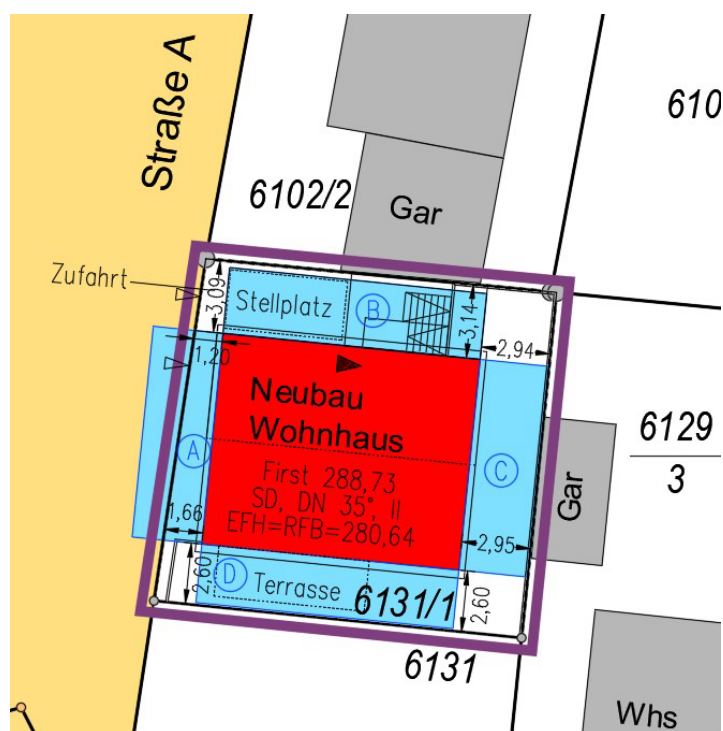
Beispiel Auszug Lageplan Baden-Württemberg – Abstandsflächen (unmaßstäblich)
